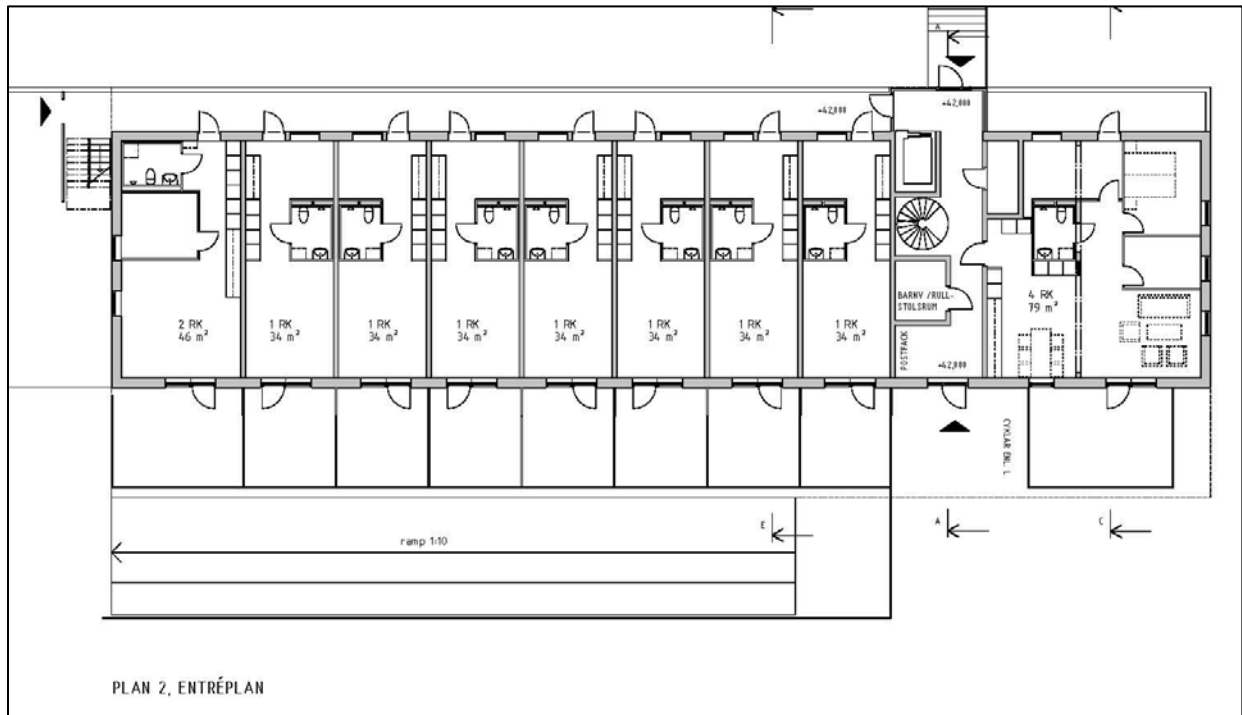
visar planlösning för lamellhusets entréplan (plan 2)
